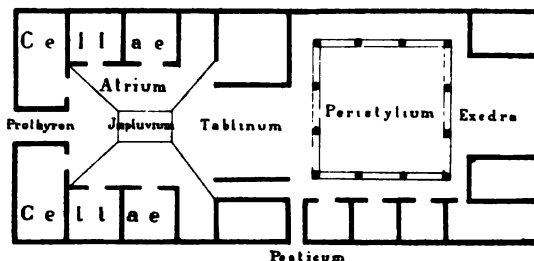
Grundriss eines pompejanischen Hauses.
